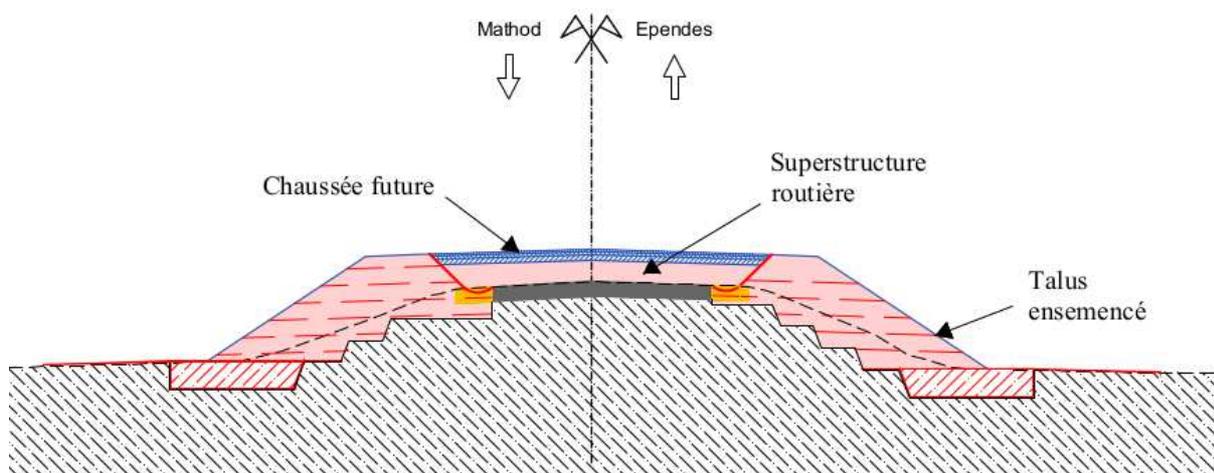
Coupe sur rampe d'accès du pont sur la Thielle avec remblais de préchargement (état final)
